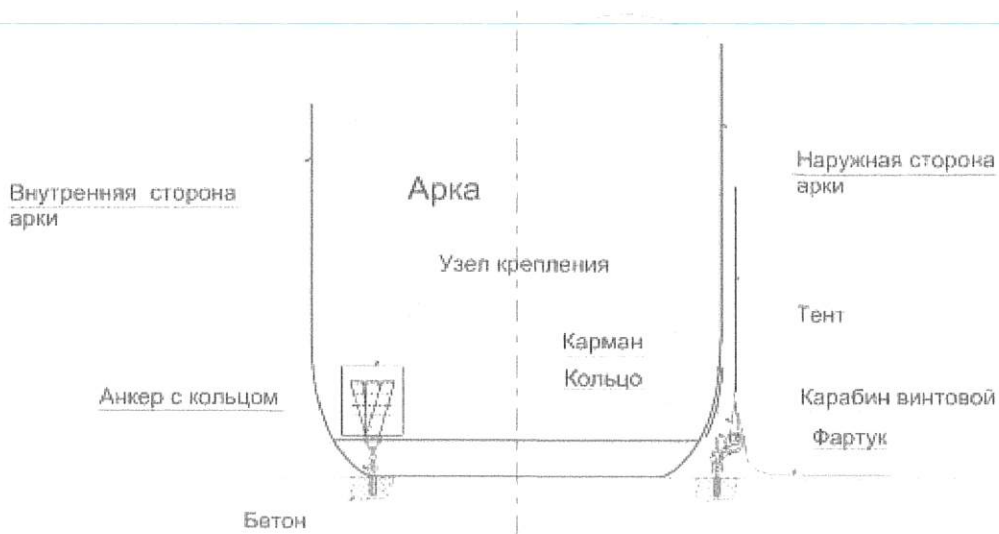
б. Схема крепления баллонов к фундаменту и натяжения накладки при помощи анкерных болтов
